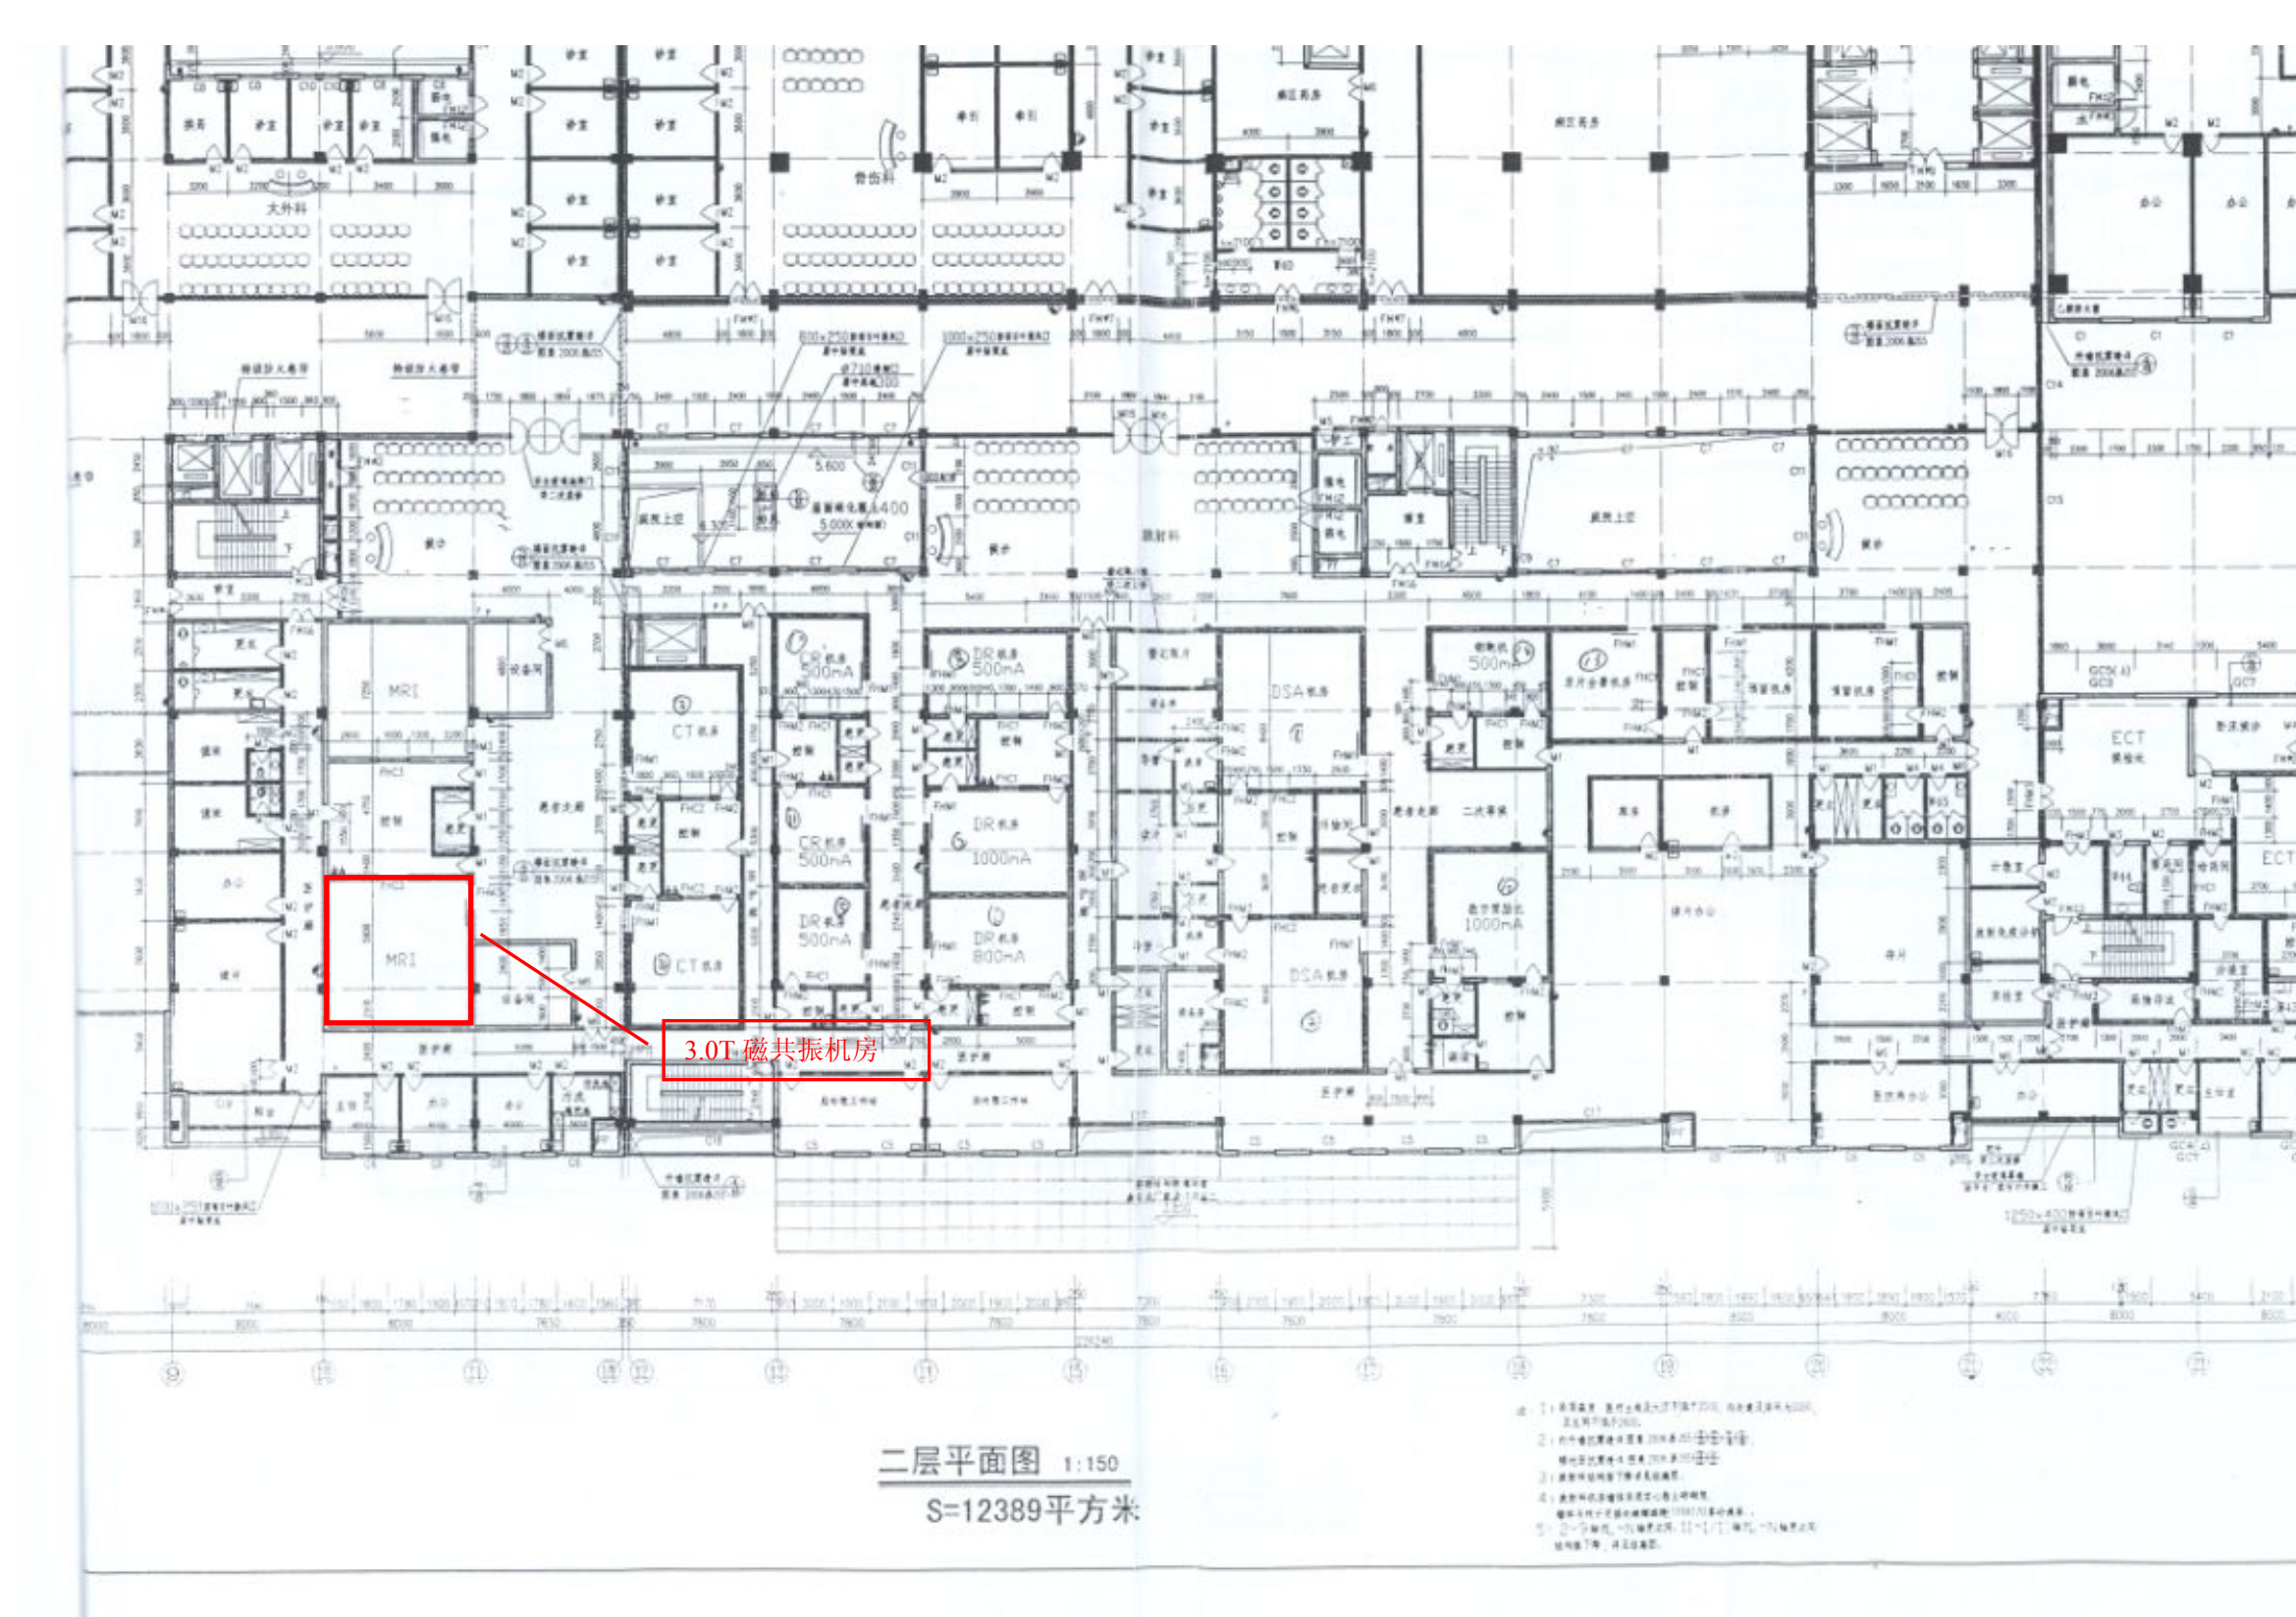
本次验收 3.0T 磁共振仪机房平面布置图
